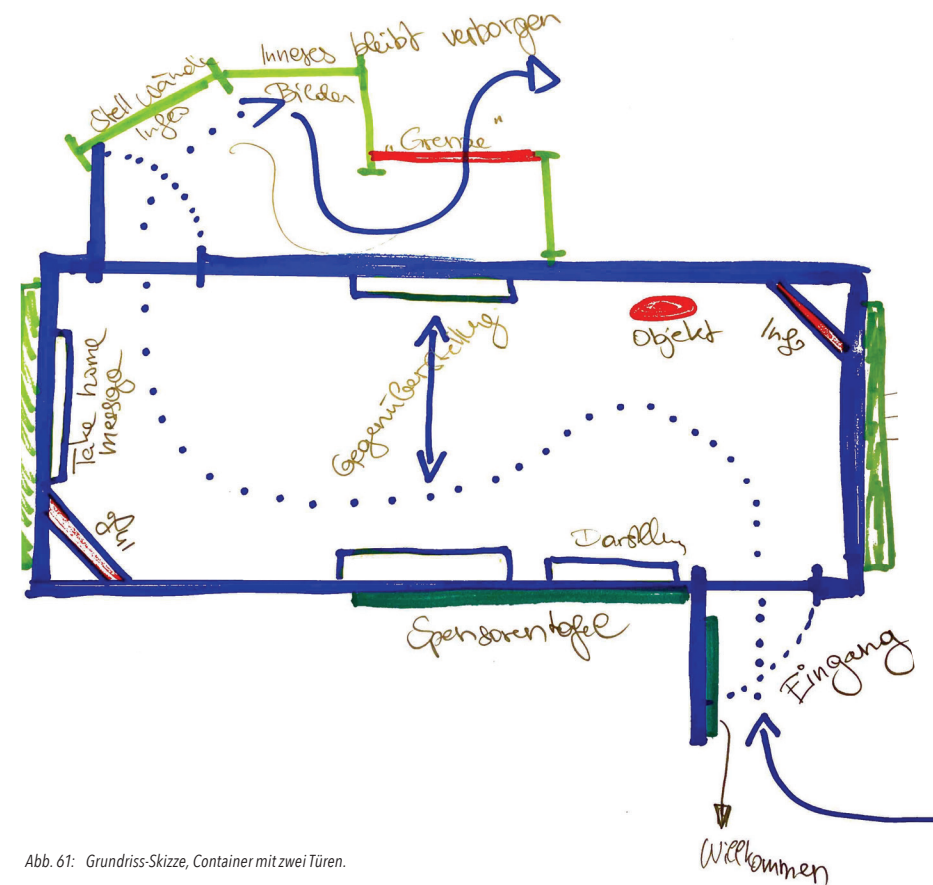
Grundriss-Skizze, Container mit zwei Türen.
